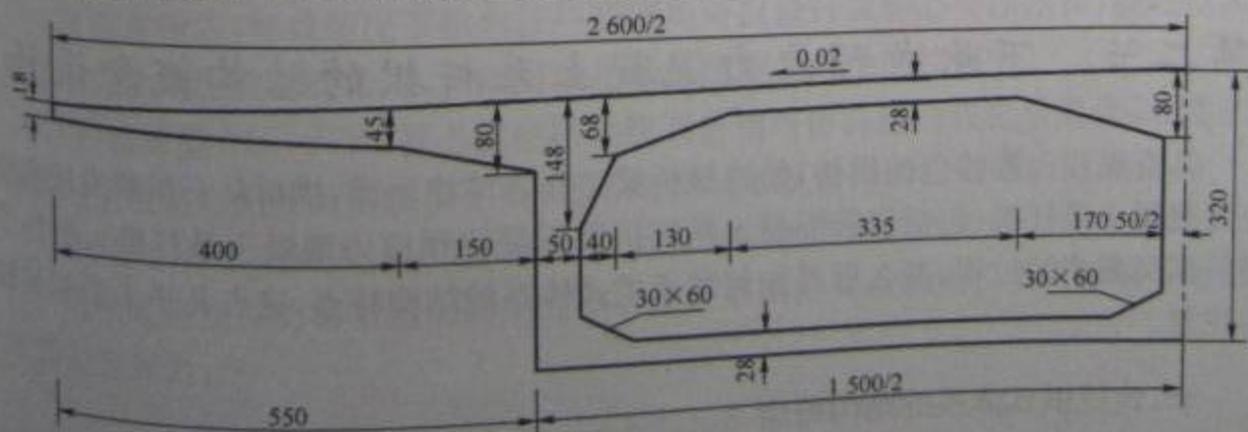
三里大桥主桥半跨中截面(尺寸单位:cm)
